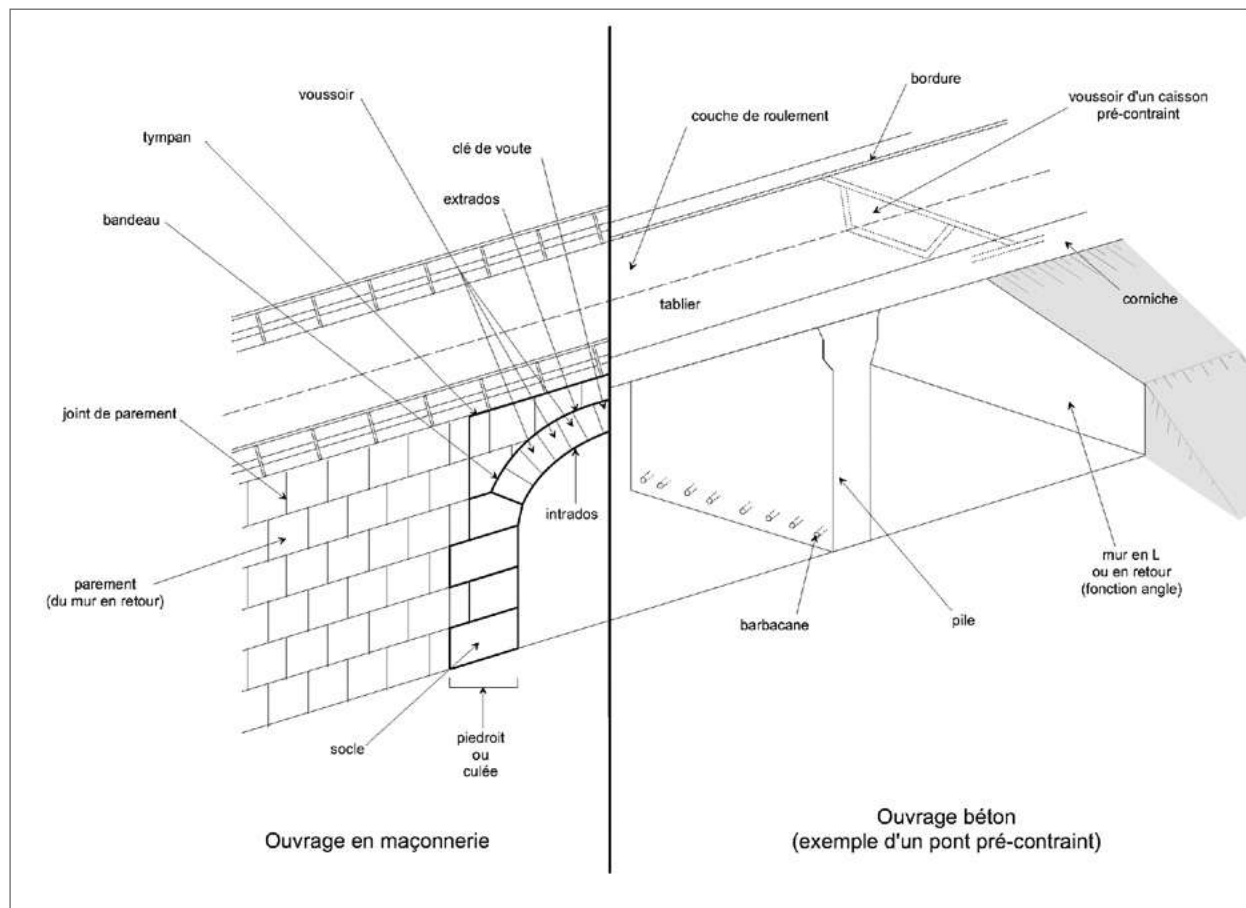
Schéma type d'un ouvrage (Source : Cerema - Est)
